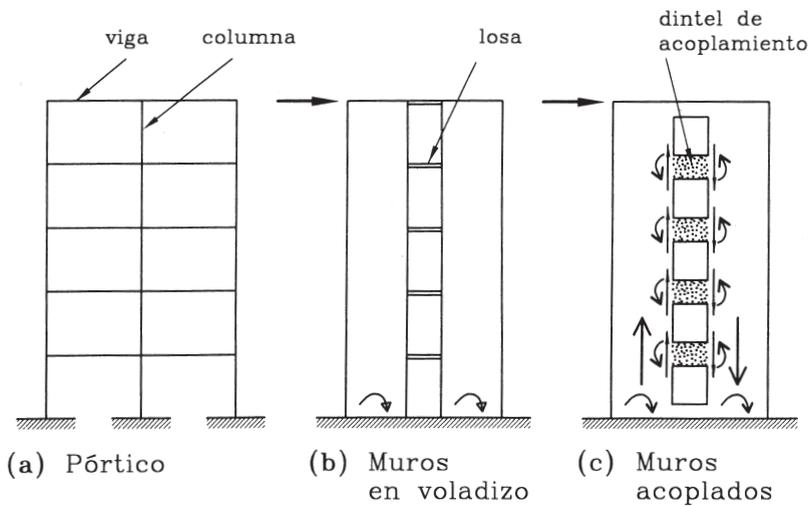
Tipos de estructuraciones para cargas horizontales
